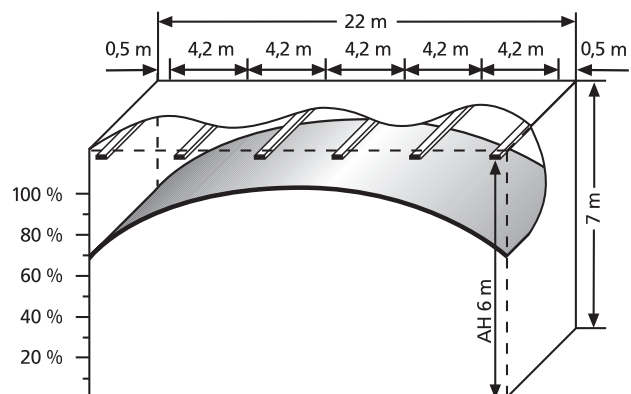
b Gleichmäßig Deckenstrahlflächenaufteilung
